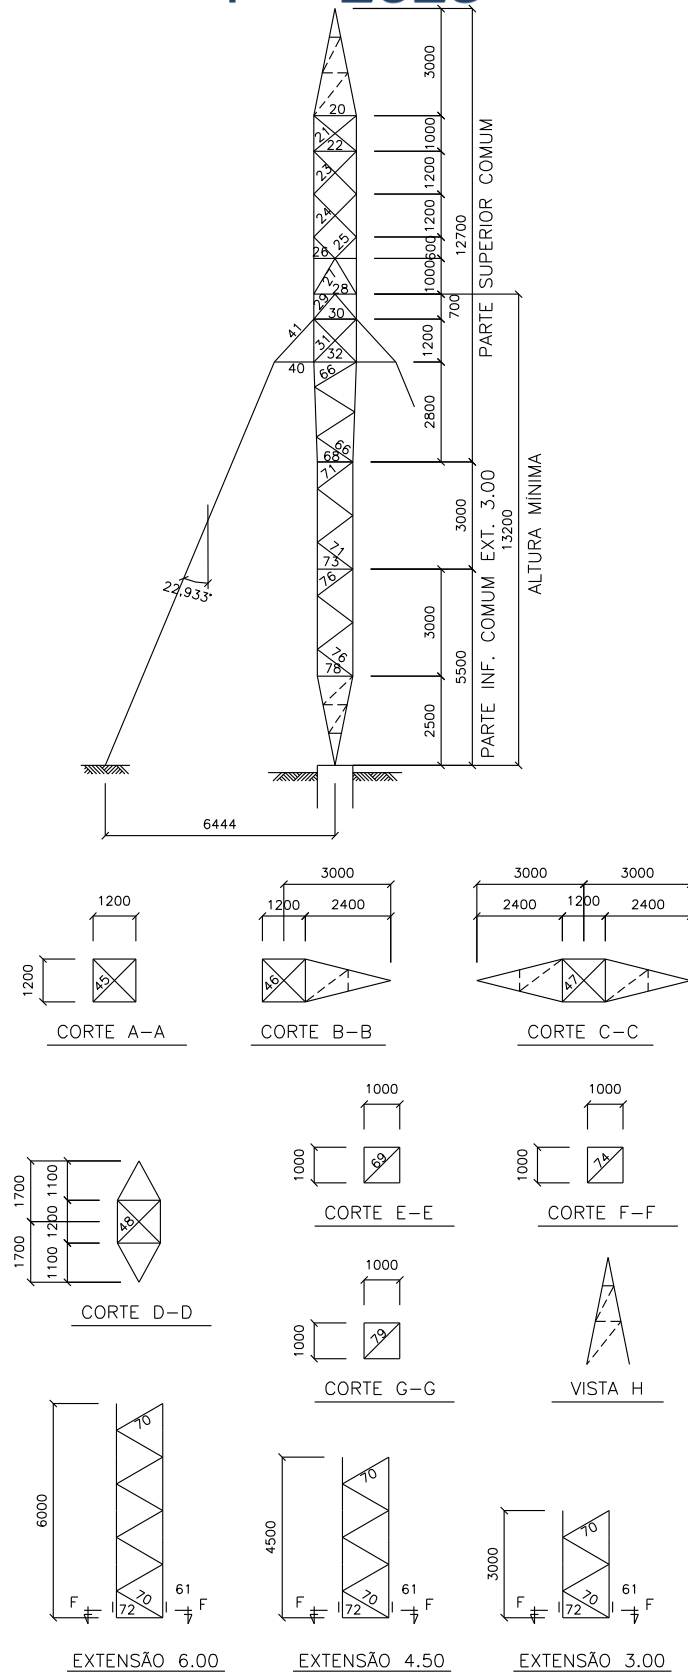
Face longitudinal, cortes e vistas da silhueta da torre
